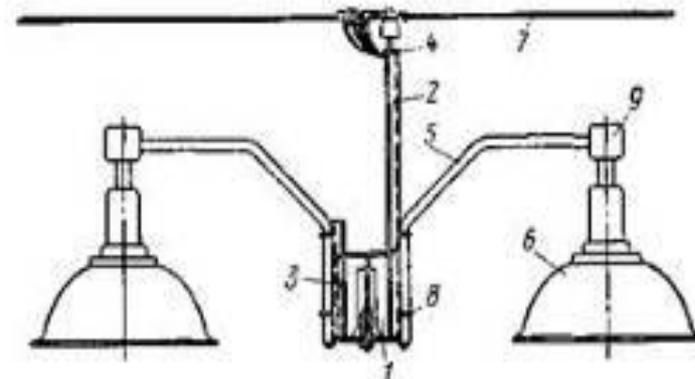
Крепление светильников и осветительной сети, выполненной проводами на изоляторах, к нижнему поясу металлической фермы: 1- основные закрепа, 2-стойка универсальная, 3-стойка, 4-траверса, 5-кронштейн, 6-светильник, 7-провода, 8-хомутик, 9-коробка
